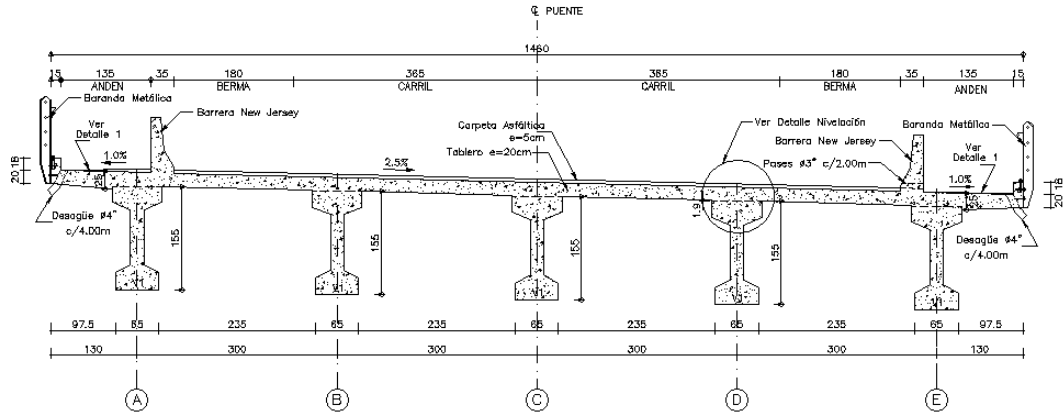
Sección transversal puente San Pedro – Zona vigas postensadas y tablero
